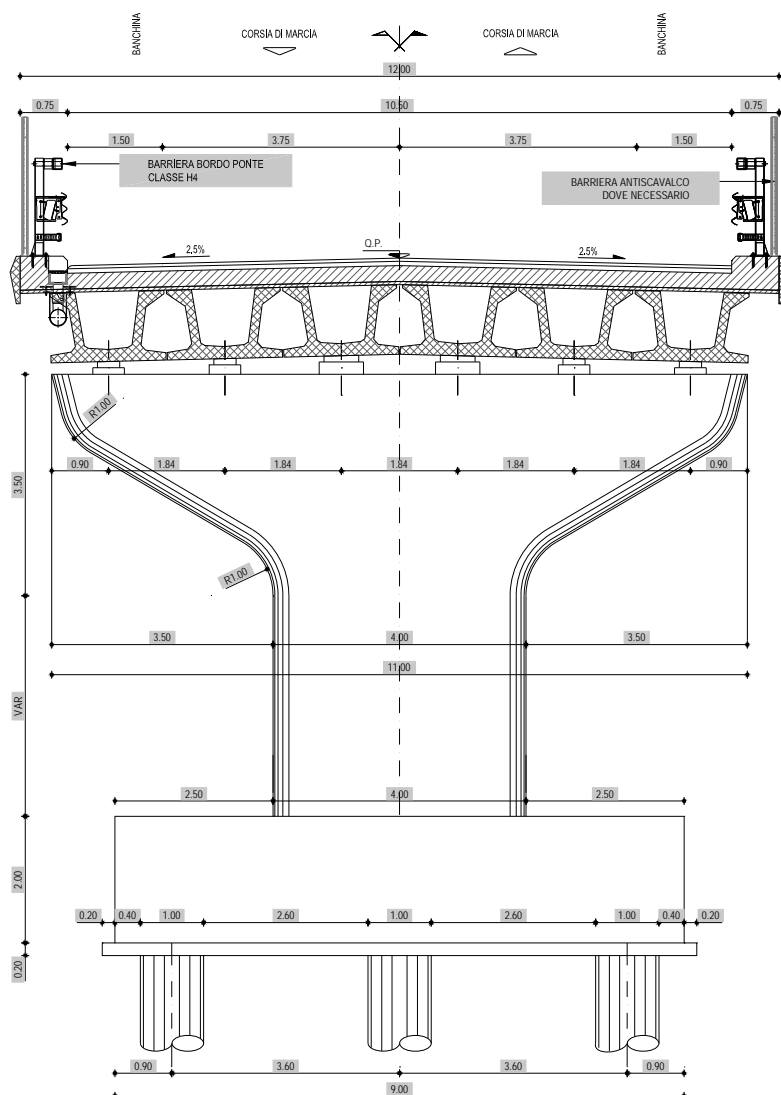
Esempio di sezione di tipo C1 in viadotto (per campate L= 25 m) e in rettilo.
